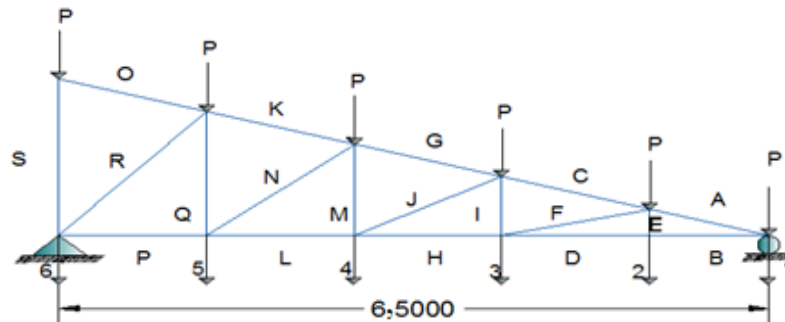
, Cargas actuantes sobre la cercha metálica, Elaboración propia
